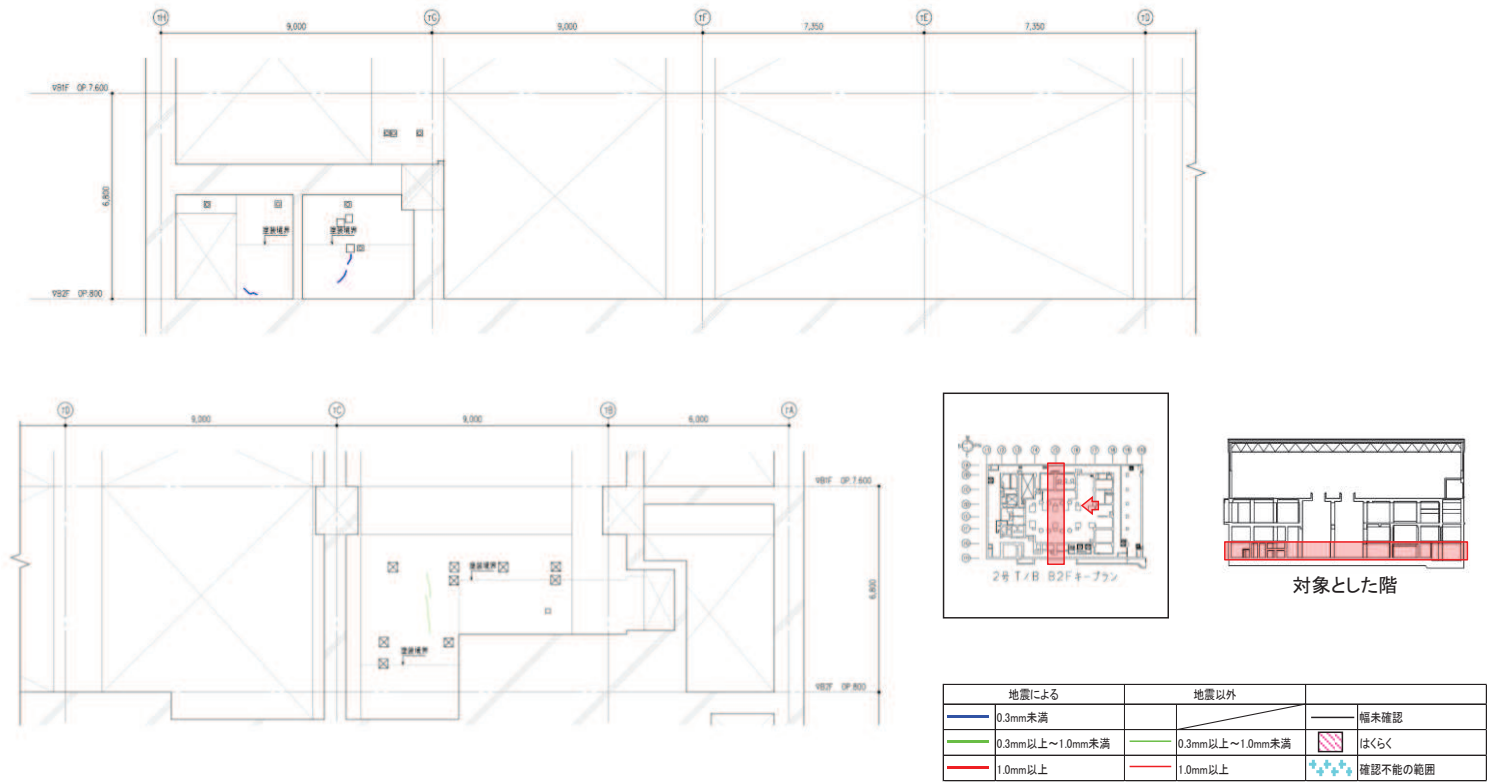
タービン建屋のひび割れ分布 耐震壁 (5) 地下2階 T5 通り
